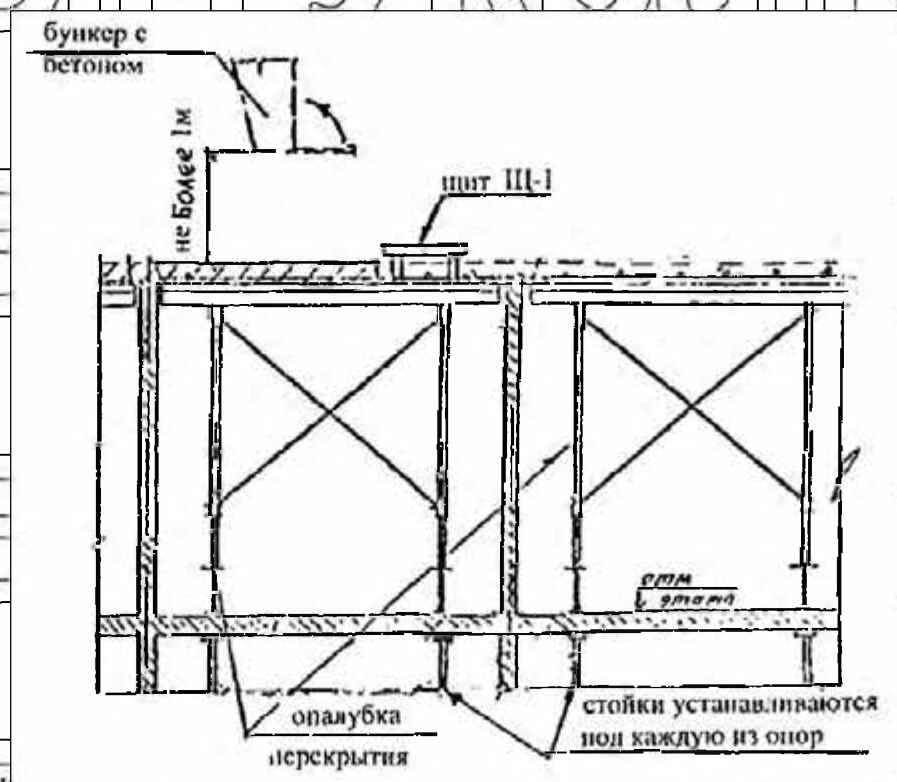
Вивання бетонтаженої суміші з бунка в опалубку перекриття
